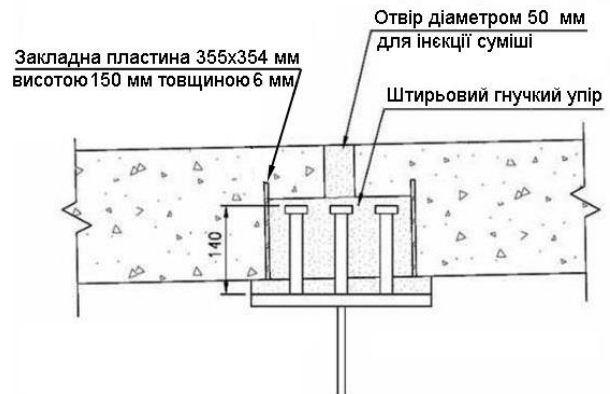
Варіант поєднання залізобетонної плити та металевої балки
